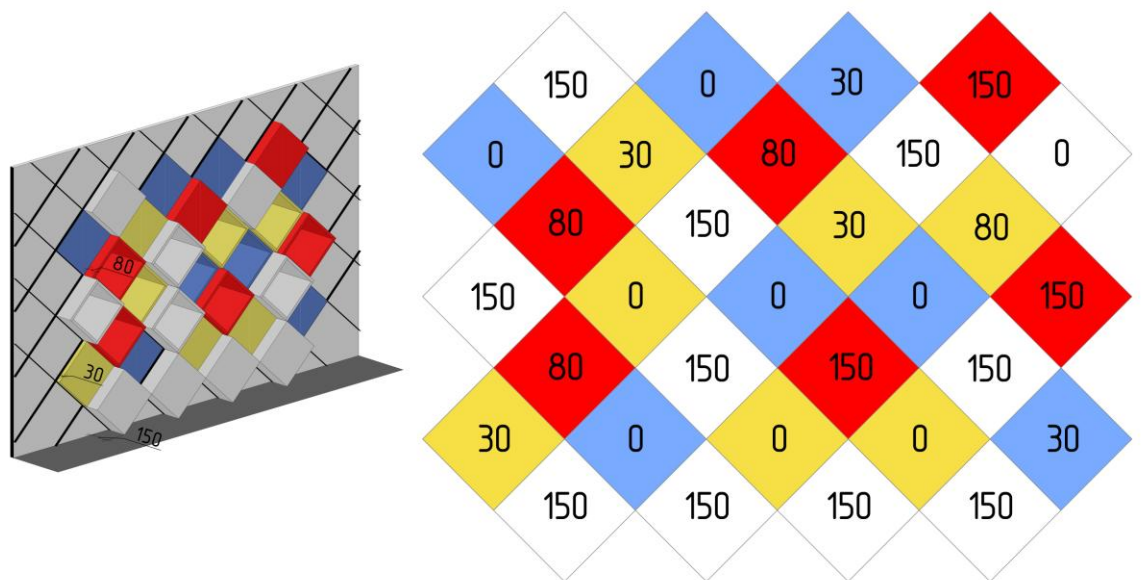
Фрагмент стенда библиотеки. Цветовая раскладка с размерами выступов из стены
